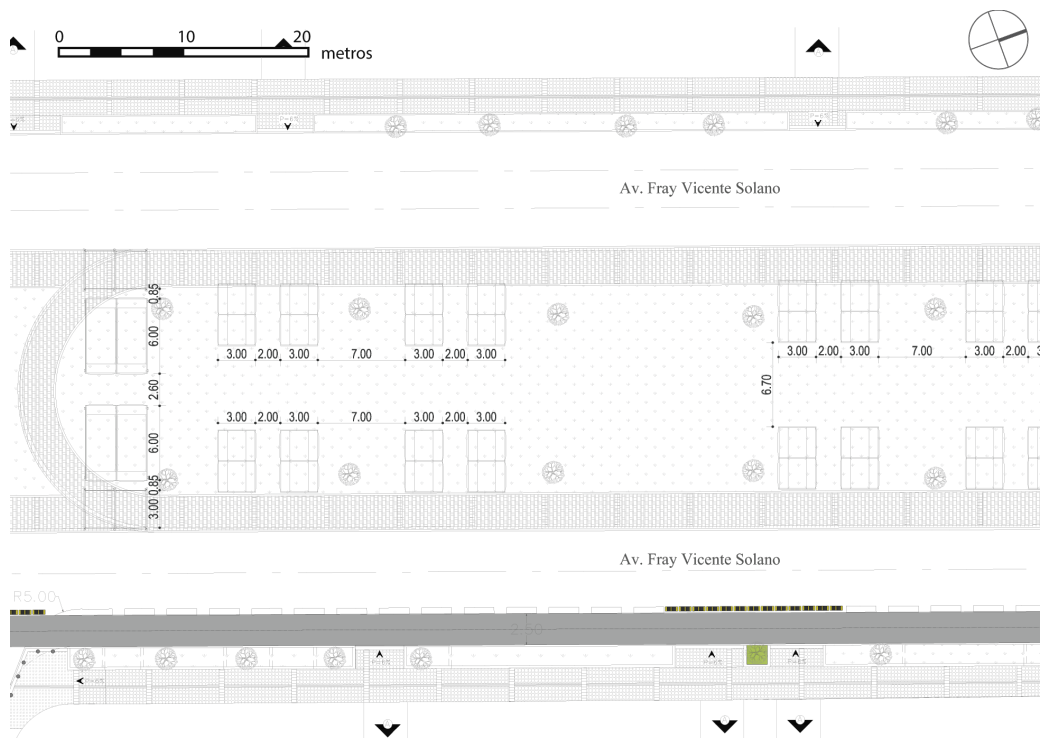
Emplazamiento del Tramo 1B. Elaboración: Autores.
